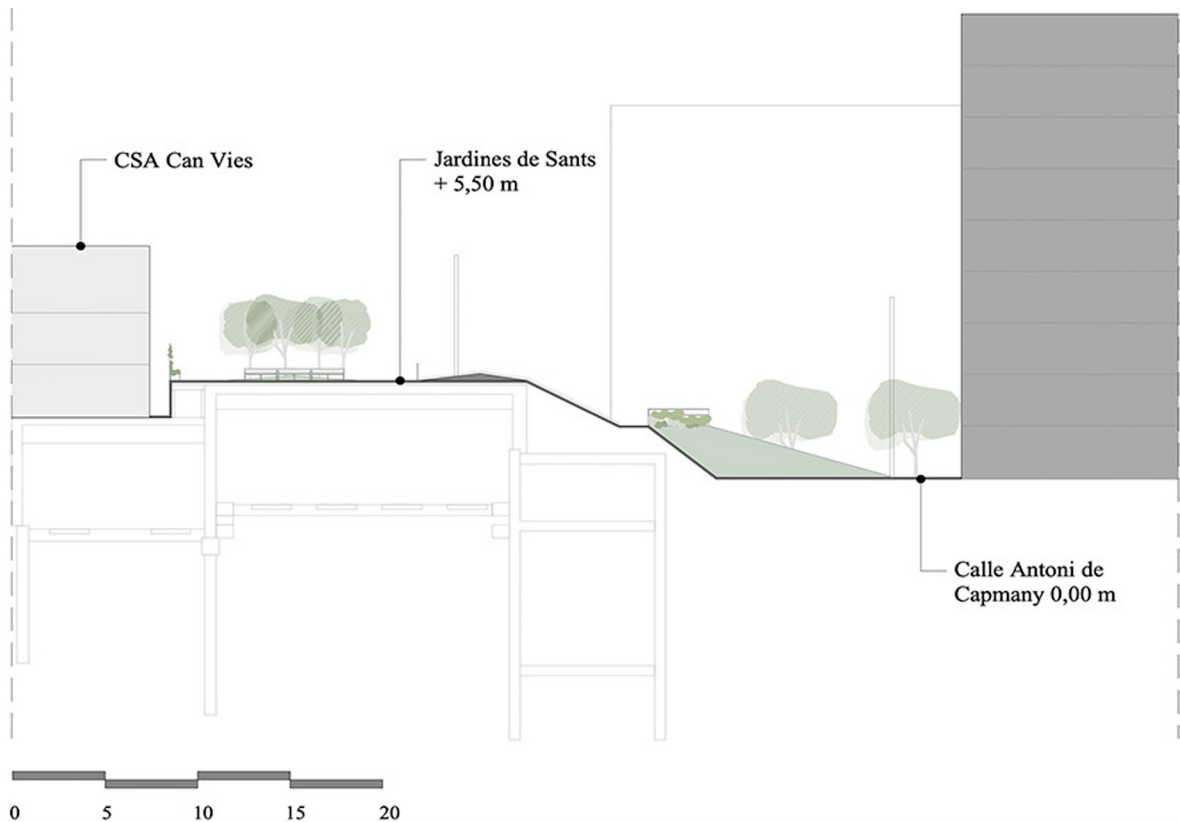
Planta - Sección 1 - Primer punto del recorrido. (2024)
